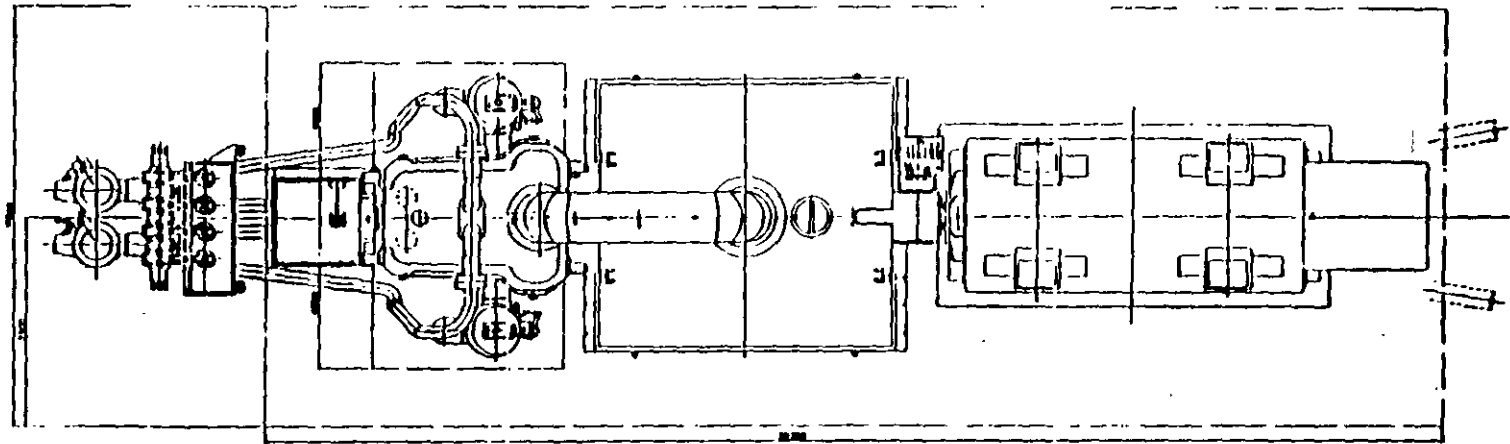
Casa de Máquinas: Arreglo de Equipo Piso de Operación Planta Niv. 12.000 m.
